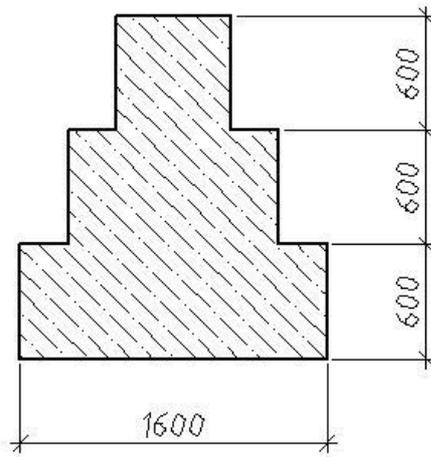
Схема фундамента мелкого заложения под колонну в осях 6-И
